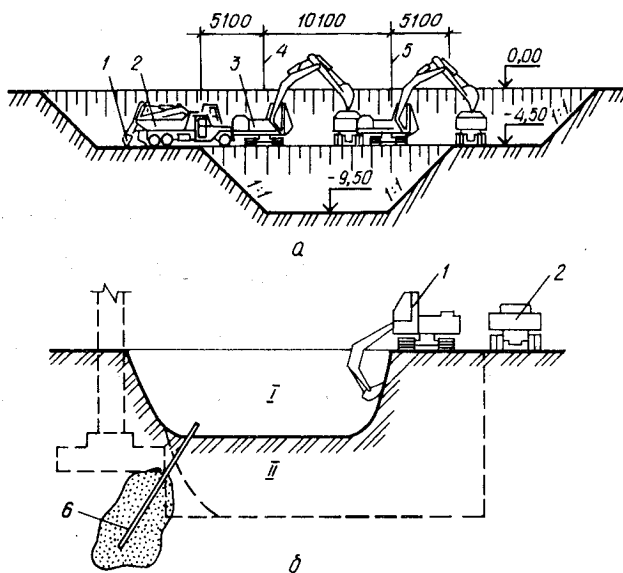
Разработка грунта в котловане в два яруса:
